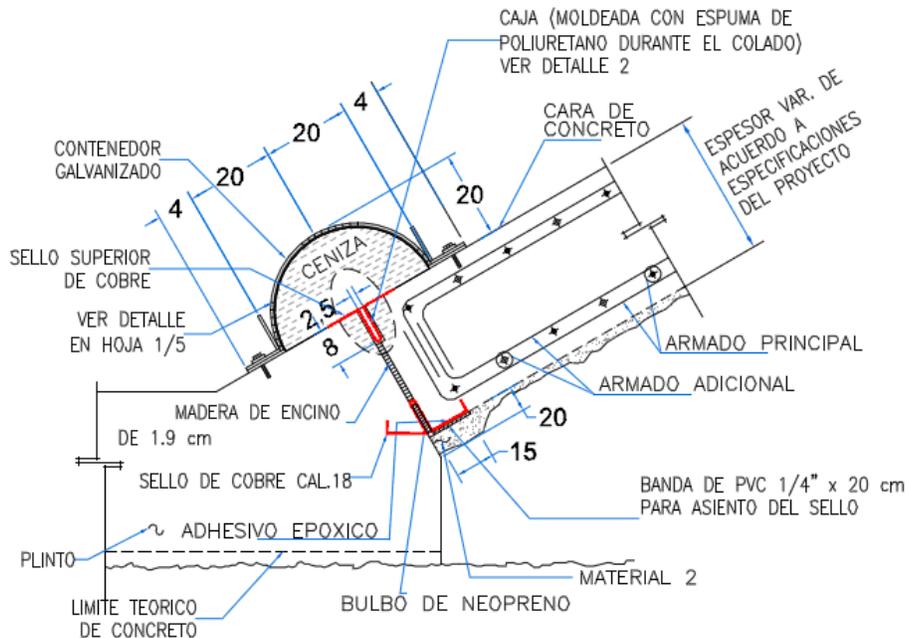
Detalle de la junta perimetral (Tipo 1)
